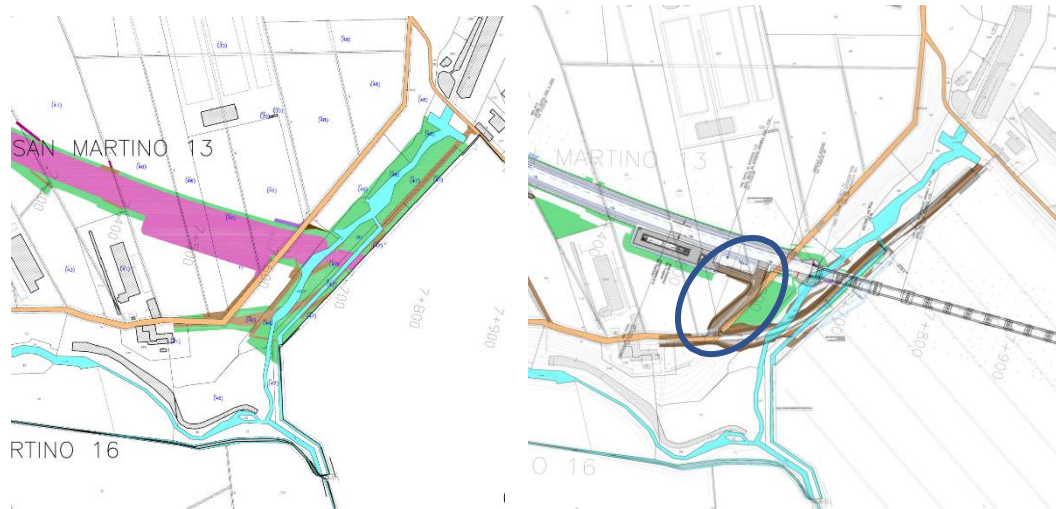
Stralcio Piano Particellare di esproprio PD, stralcio Piano Particellare di esproprio (PE) con sovrapposta la planimetria di progetto, le nuove aree di occupazione sono evidenziate con cerchio blu
